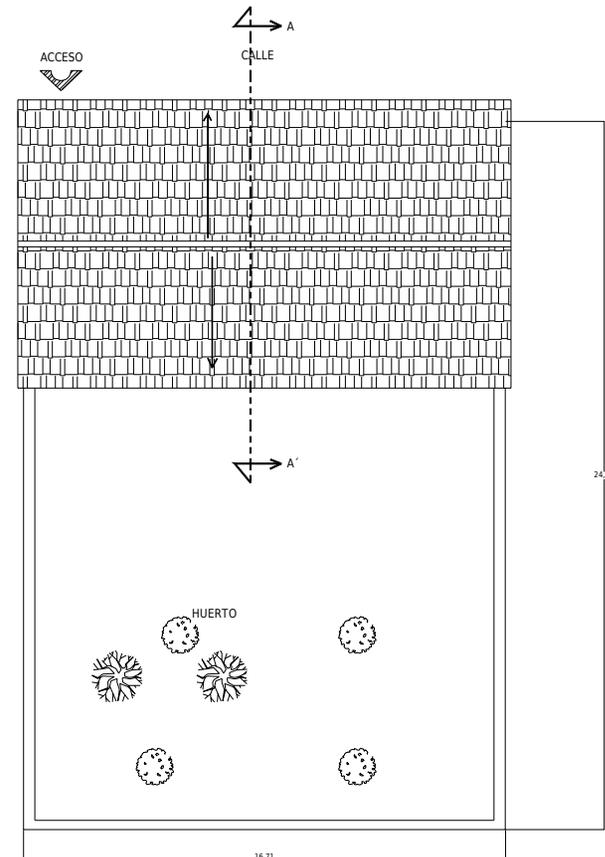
, PLANTA DE CONJUNTO DE LA VIVIENDA TIPO.
